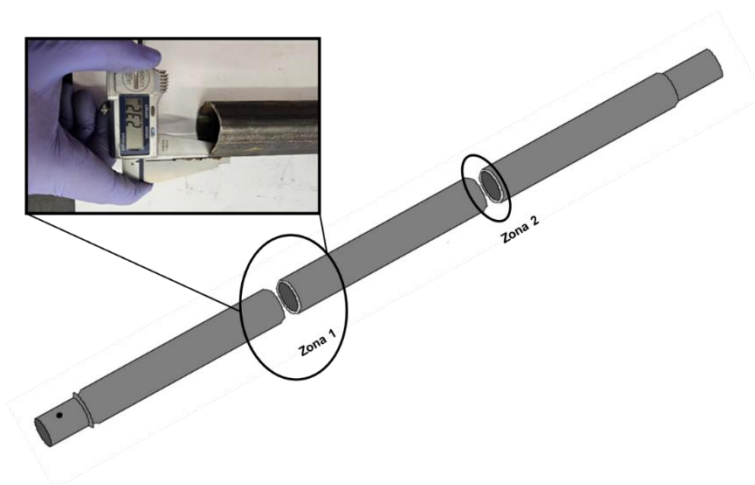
Ilustração de parafuso do tipo expansivo, após expansão e corte, para medição da espessura do aço e pormenor da medição efetuada com um paquímetro.
